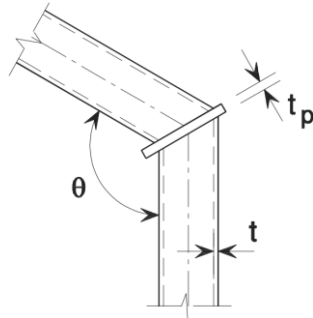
JUNTA SOLDADA EM COTOVELO REFORÇADA COM CHAPA
